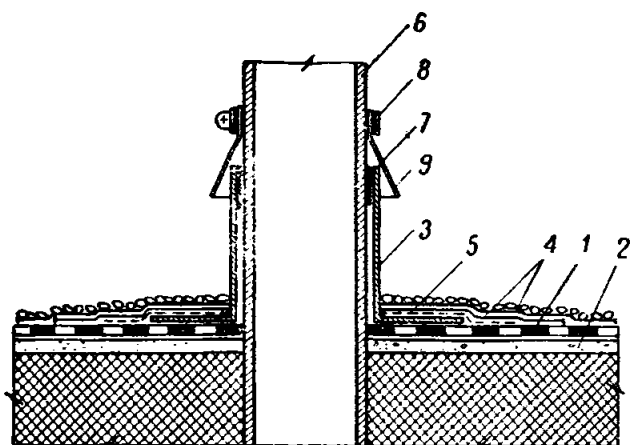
Примыкание кровли из рулонных материалов к круглым трубам, проходящим через покрытие
